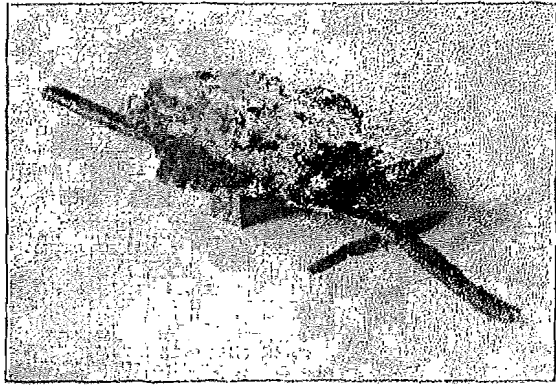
Tæret Jern fra en Jernbetonplades Overside med tilhørende Flage af Betondæklaget, der er gennemtrængt af Rust.
